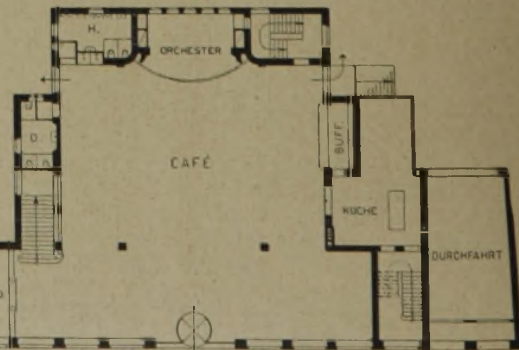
Grundriß des Erdgeschosses. Querschnitt durch das Café. (1:500).
